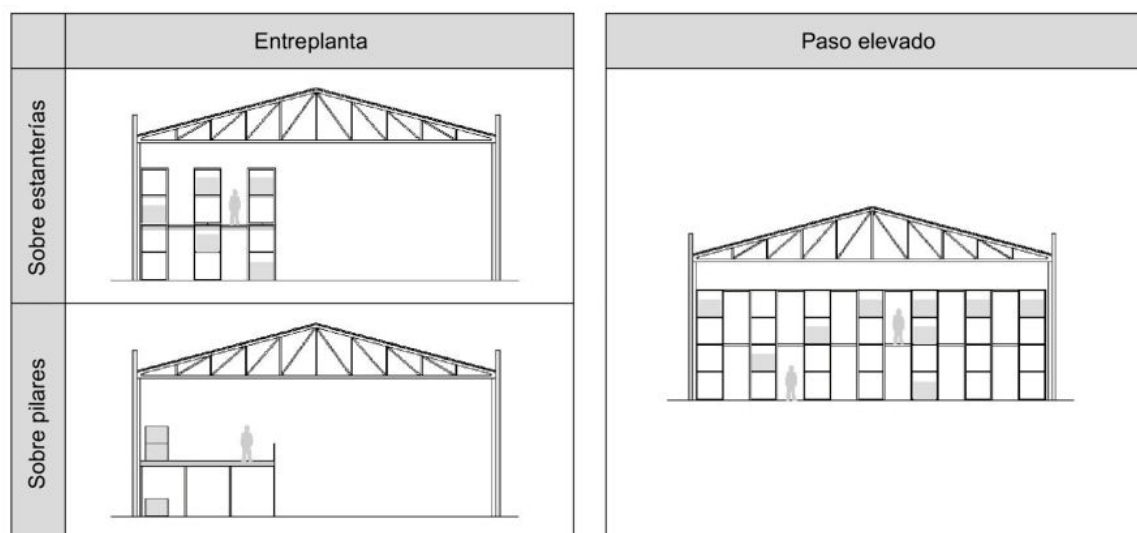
Clasificación de los pasos elevados y entreplantas
